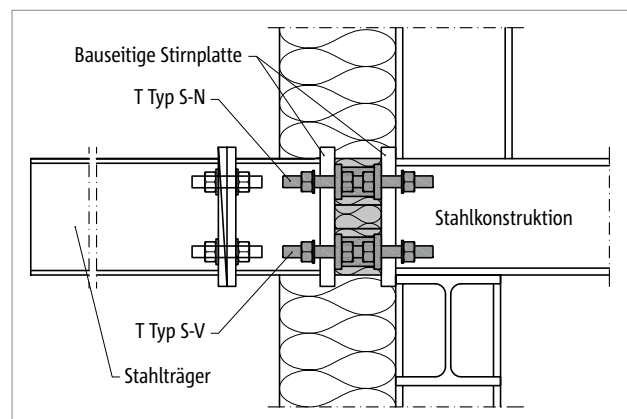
Schöck Isokorb® T Typ S: Stahlkonstruktion frei auskragend; Adapter bauseitig
